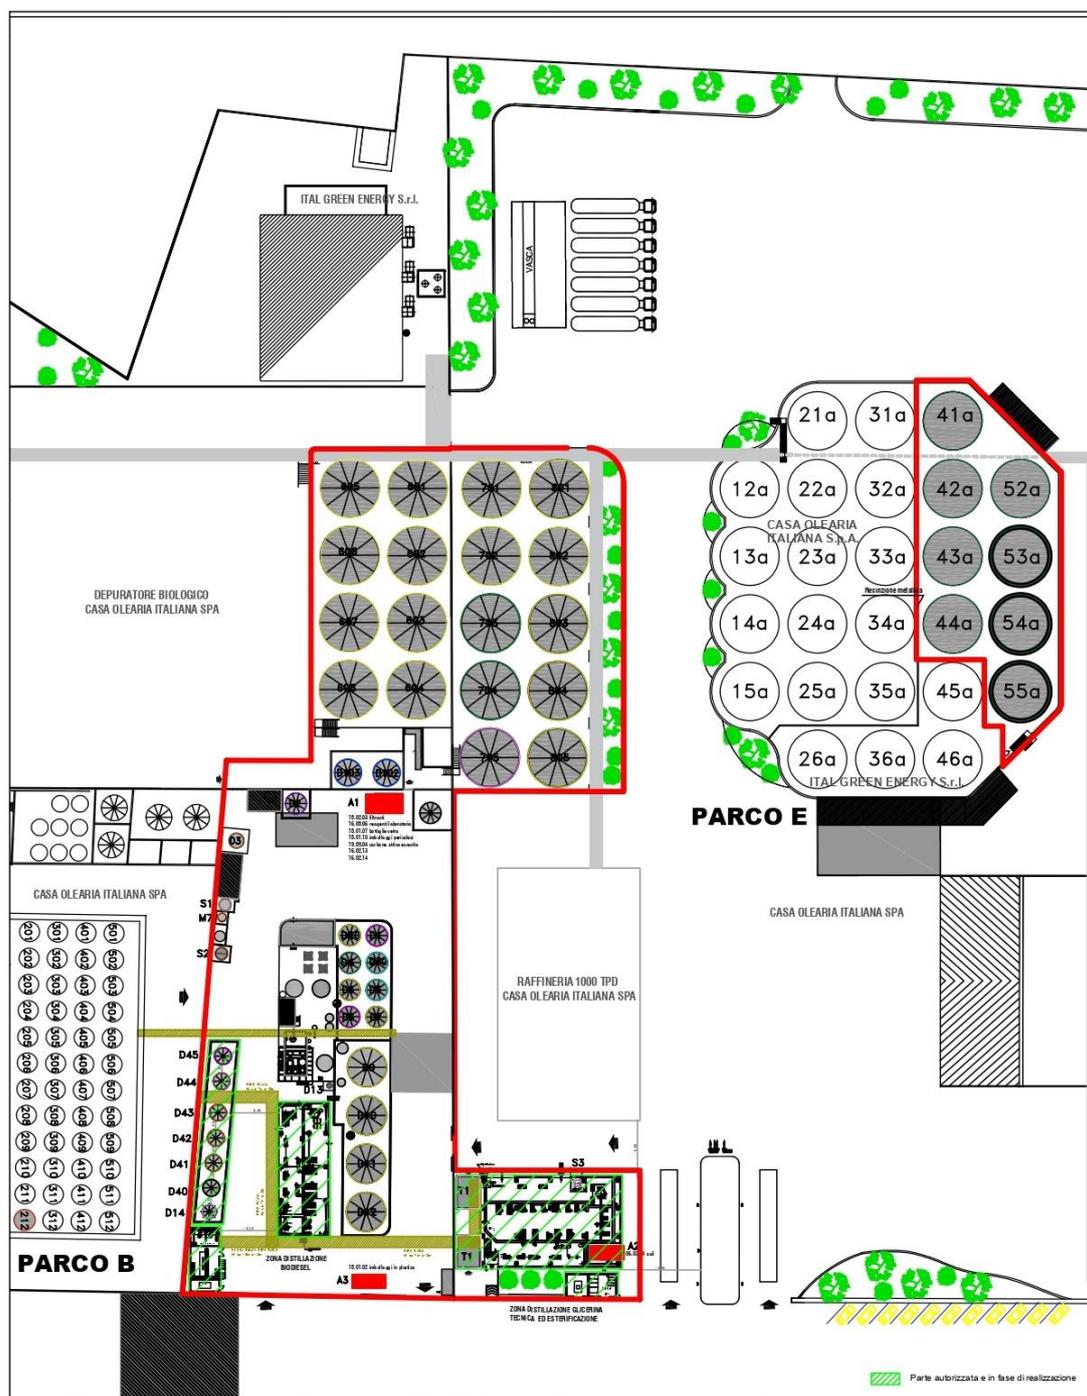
Planimetria impianto Ital Bi Oil stato attuale
